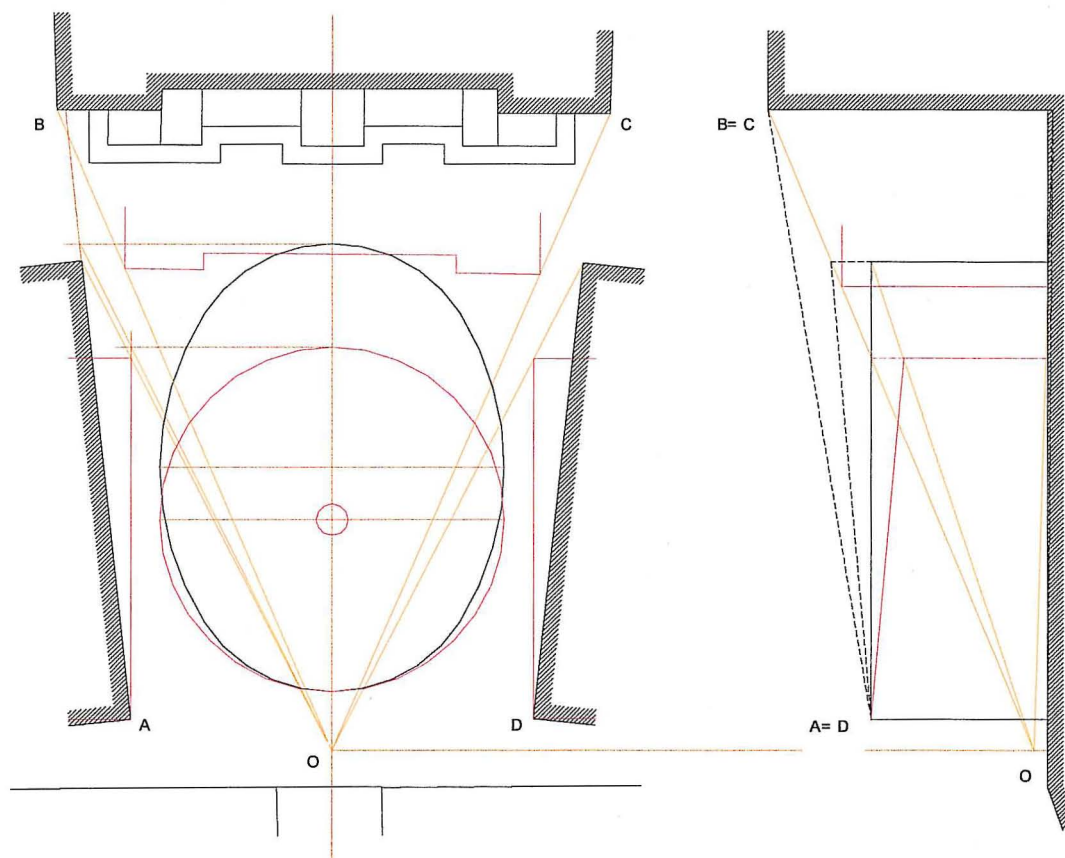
Reconstituição do espaço virtual da Praça do Capitólio em planta e em corte
